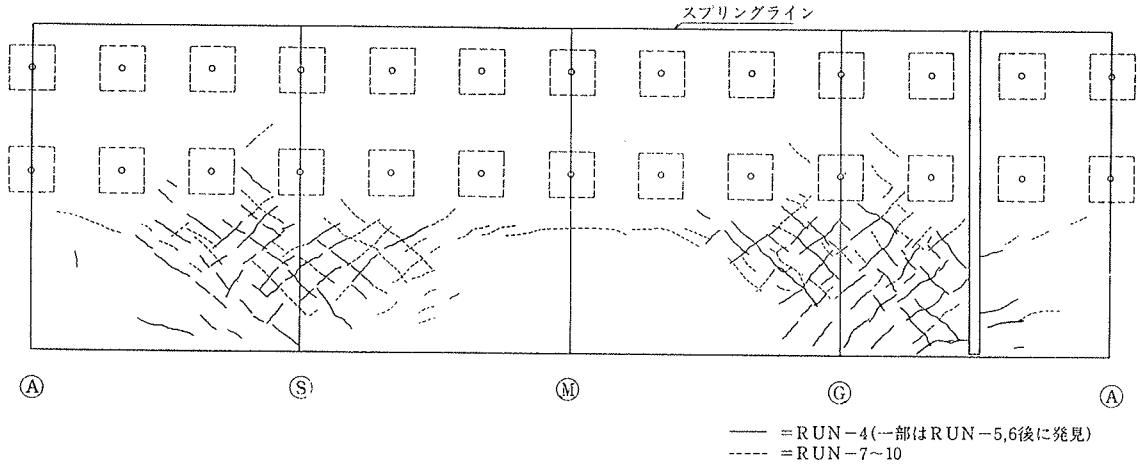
(1) ひび割れ発生状況 (RUN-4 及び RUN-10 終了時)
